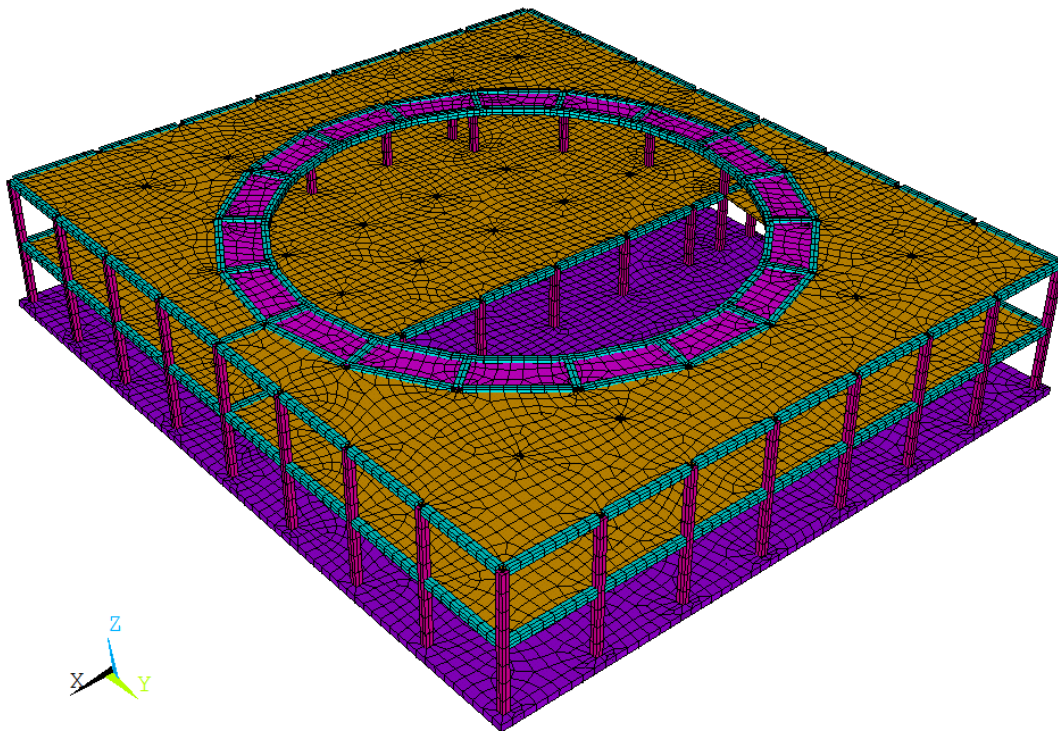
Разработанная КЭ-модель подсистемы «основание – железобетонные конструкции каркаса» входного блока ТЦ «Волгамолл».
